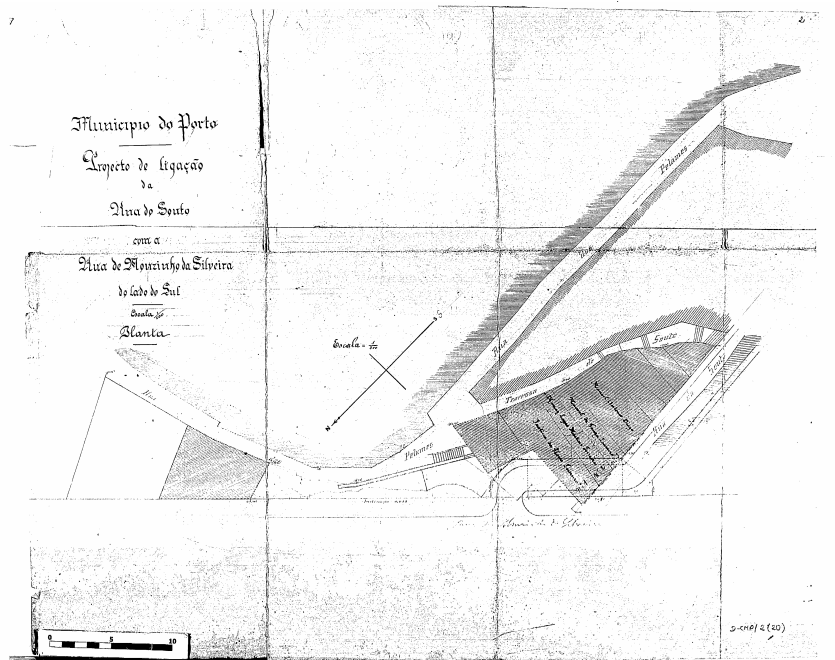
Projecto de Ligação da Rua do Souto com a Rua Mouzinho da Silveira do lado sul - planta ( A.H.M.P. D-CMP-02-020-002)
